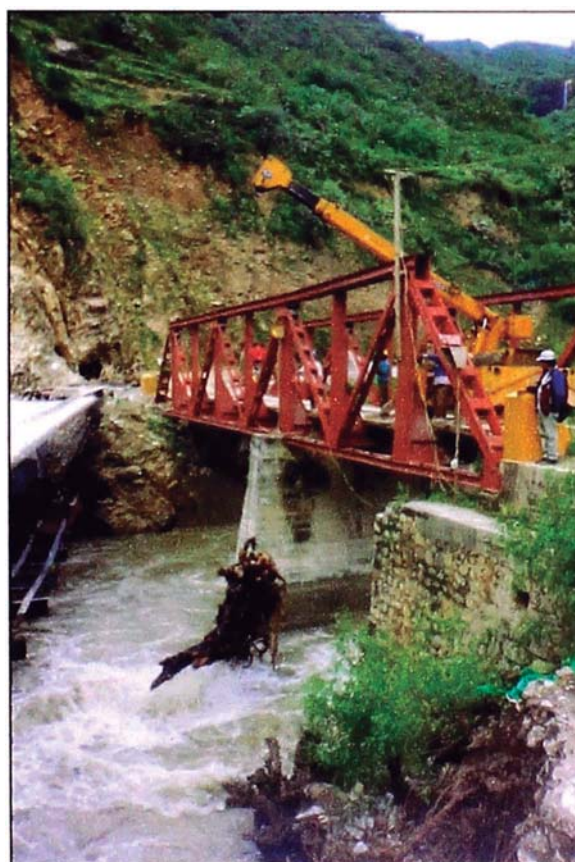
Equipo de apoyo (grúa GROVE) para remover y retirar los elementos atrapados en el falso puente, esta prevención era constante.
